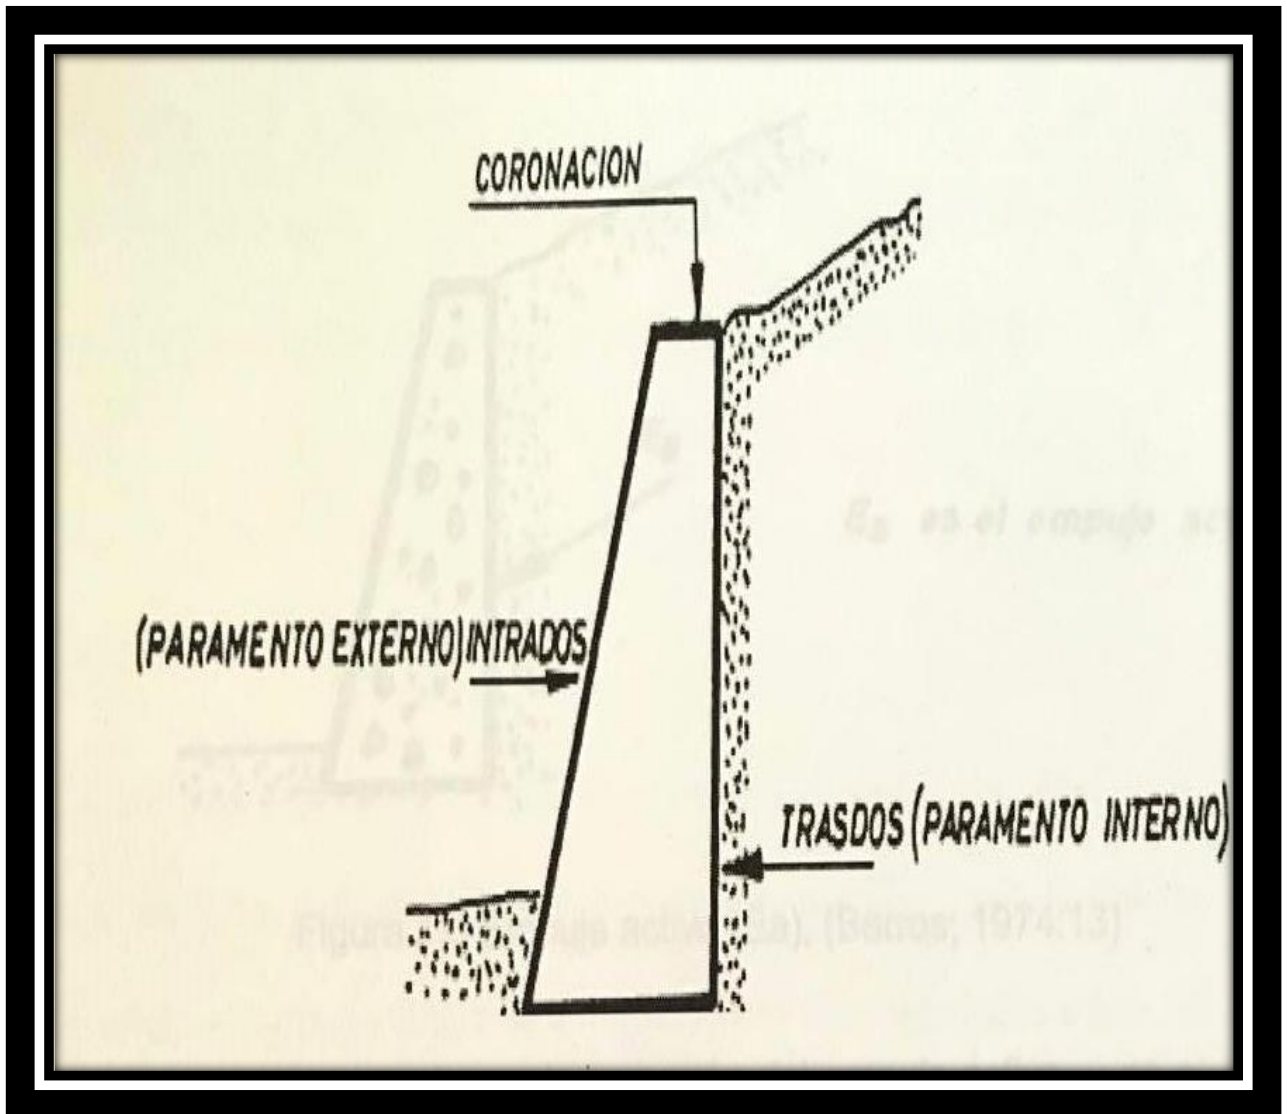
Muro de concreto en masa. (Fuente: Barros; 1947:13)
